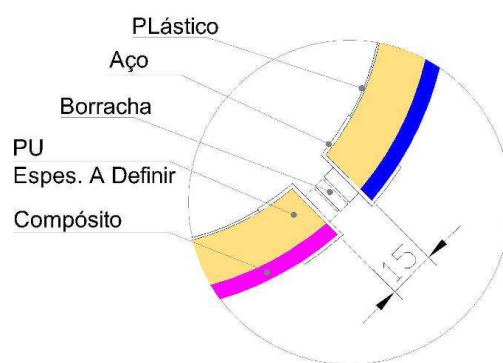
DETALHE INSTALAÇÃO DA BORRACHA
